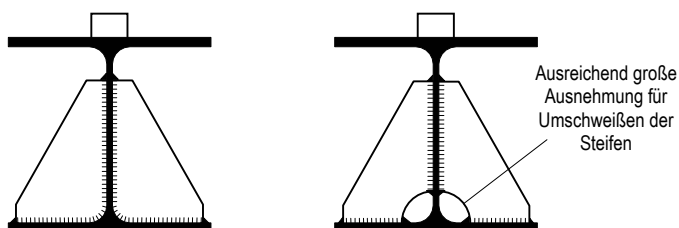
Lasteinleitungssteifen von Walzprofilen: eingepaßt und Ausrundungsbereich ausgenommen
